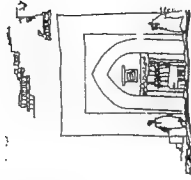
حاديت بدرب خلف الله - مسقط الفتي
